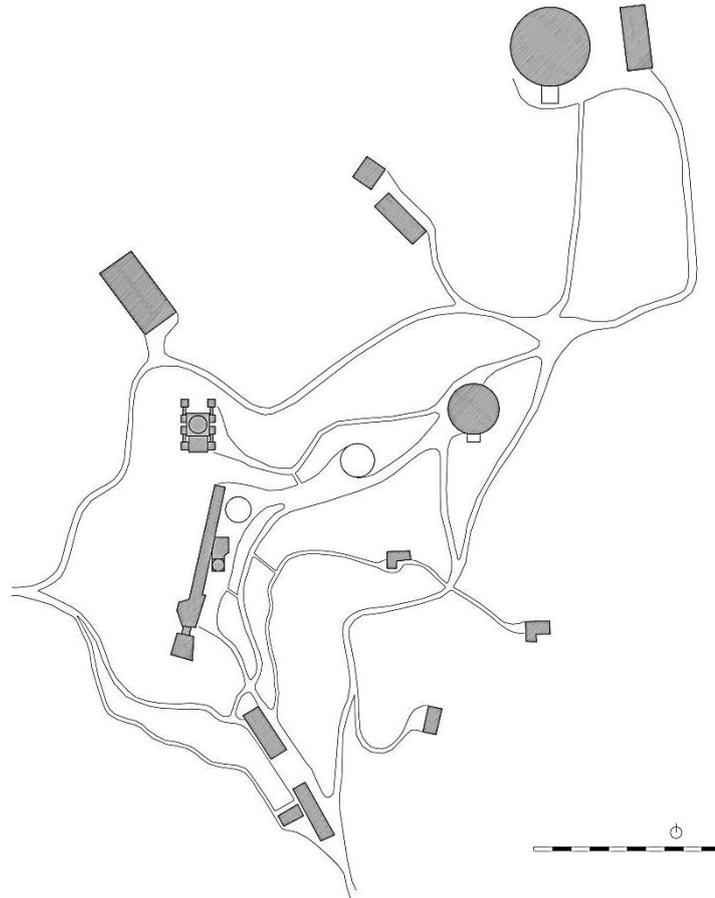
Observatorio Mount Wilson. Planta de conjunto.
